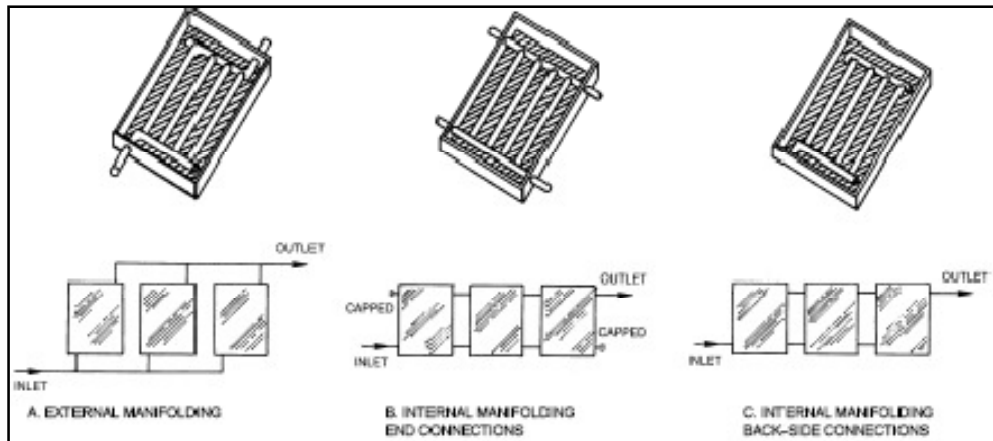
FIG.XX. Conexiones según el tipo de tubería constructiva en el captador.
